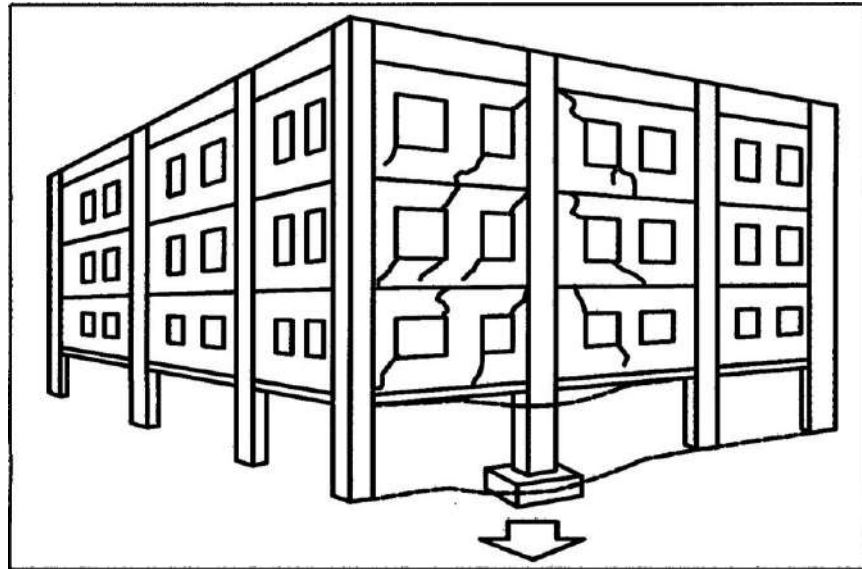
Zonas de asentamiento fisuras y fallas.
